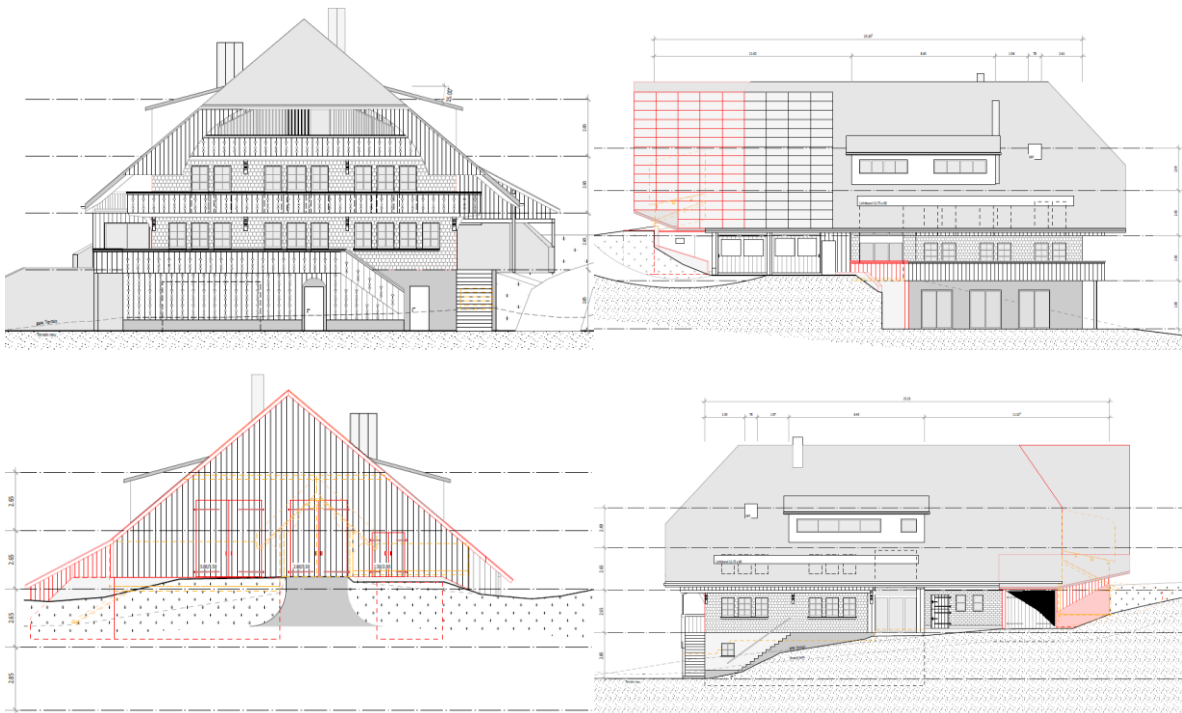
Fassadenansichten Ersatzneubau Vorder Weg 31
